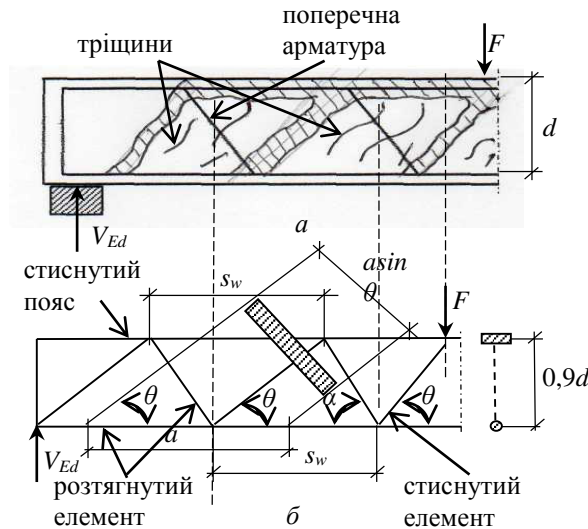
Розрахункова схема площі поперечної арматури за методом «фермової» моделі:
